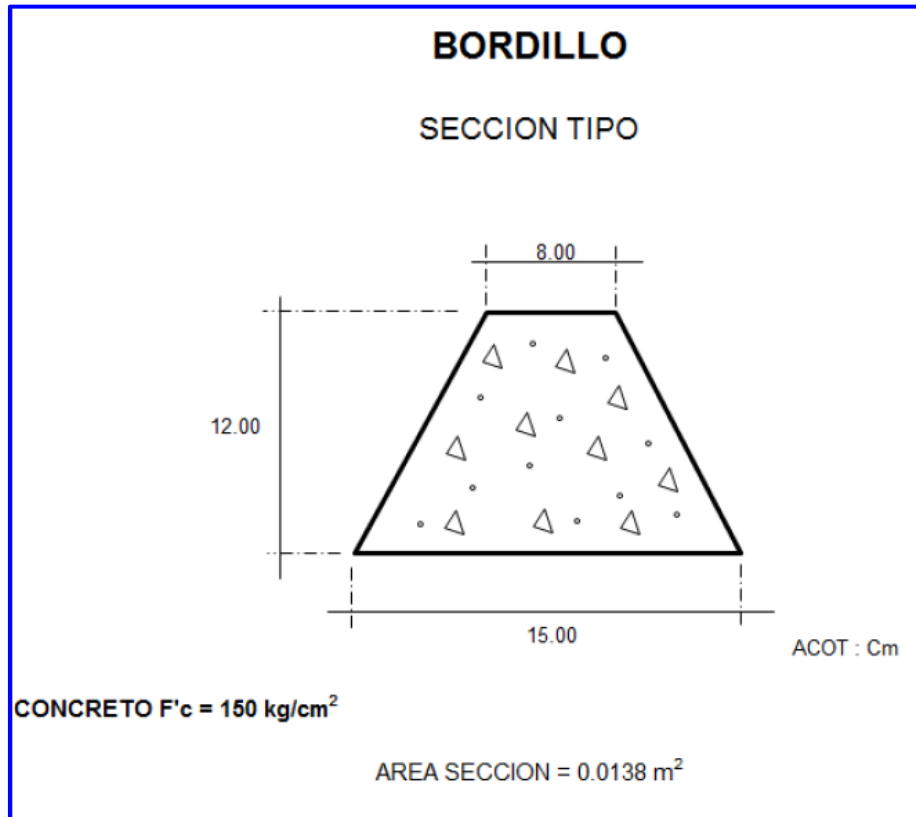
SECCIÓN TIPO DE LOS BORDILLOS QUE SE CONSTRUIRÁN PARA DELIMITAR LA CARPETA ASFÁLTICA
